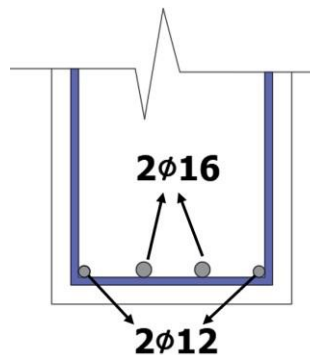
Disposición de armadura positiva en la viga.
